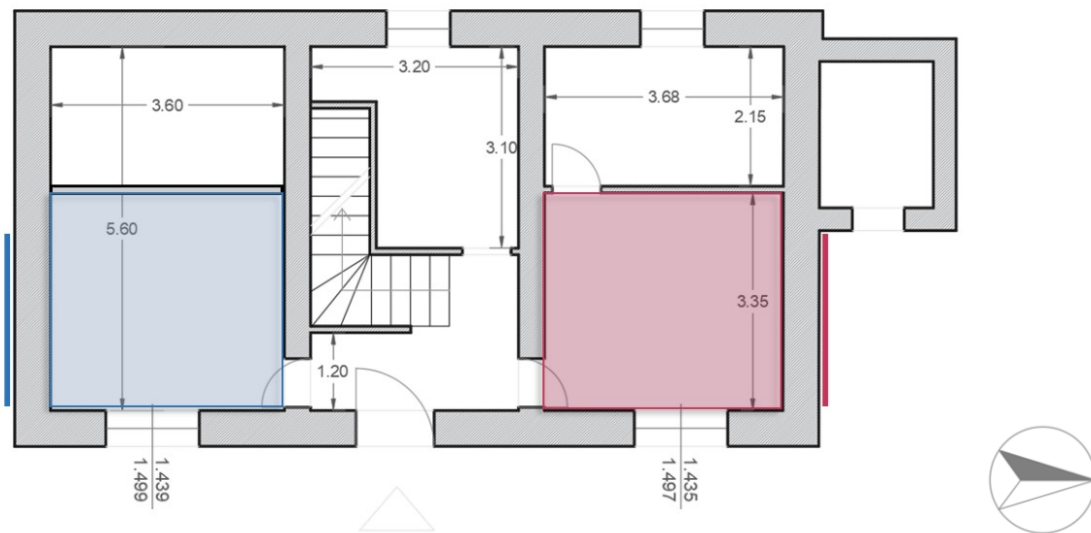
Individuazione degli interventi di isolamento ipotizzati: in azzurro la parete ventilata e in rosso l'isolamento a cappotto
